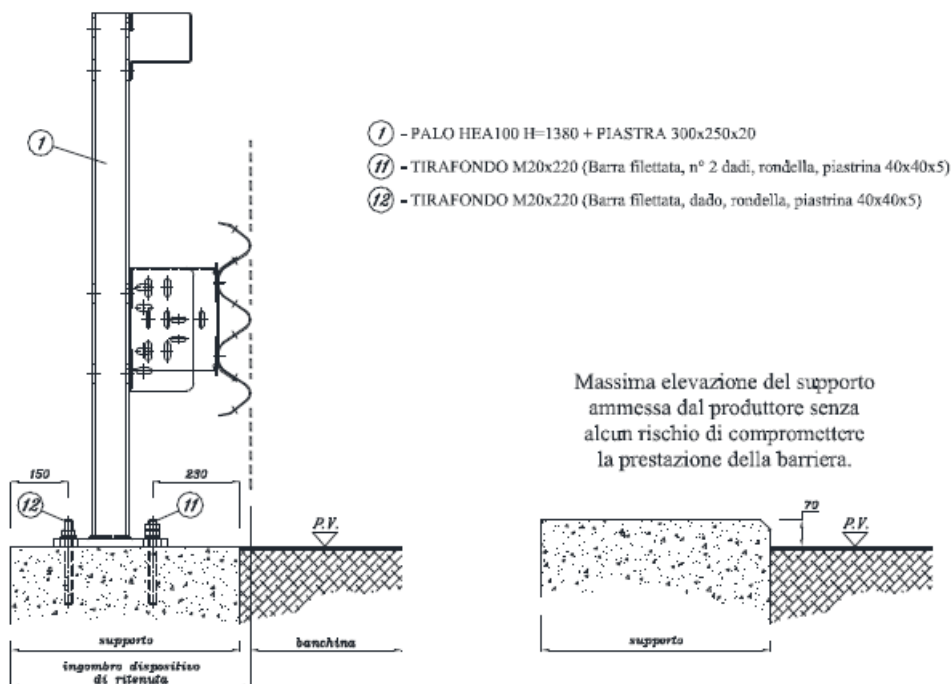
Esempio elevazione del cordolo rispetto al piano viabile (fonte Manuale di Installazione H3-BPL71)
